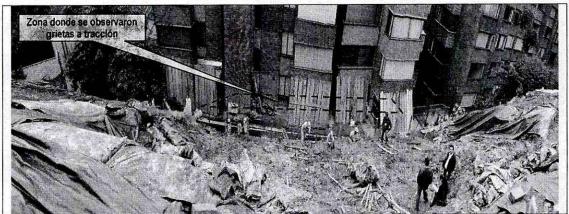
Vista parte superior (corona) del escarpe evaluado, localización de la zona donde se evidenciaron grietas a tracción en la parte media de la ladera (Fotografia tomada el 11-04-08).
